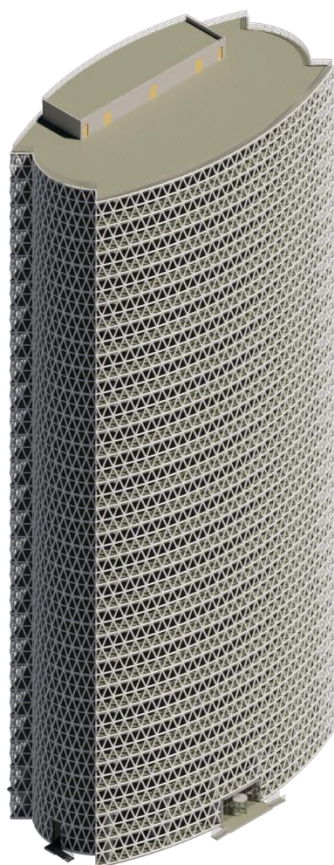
Металлический каркас системы «Diagrid»: 1-кольцевые балки, соединенные с плитой перекрытия; 2-кольцевая балка межэтажная; 3-узлы; 4-наклонные элементы [6]
